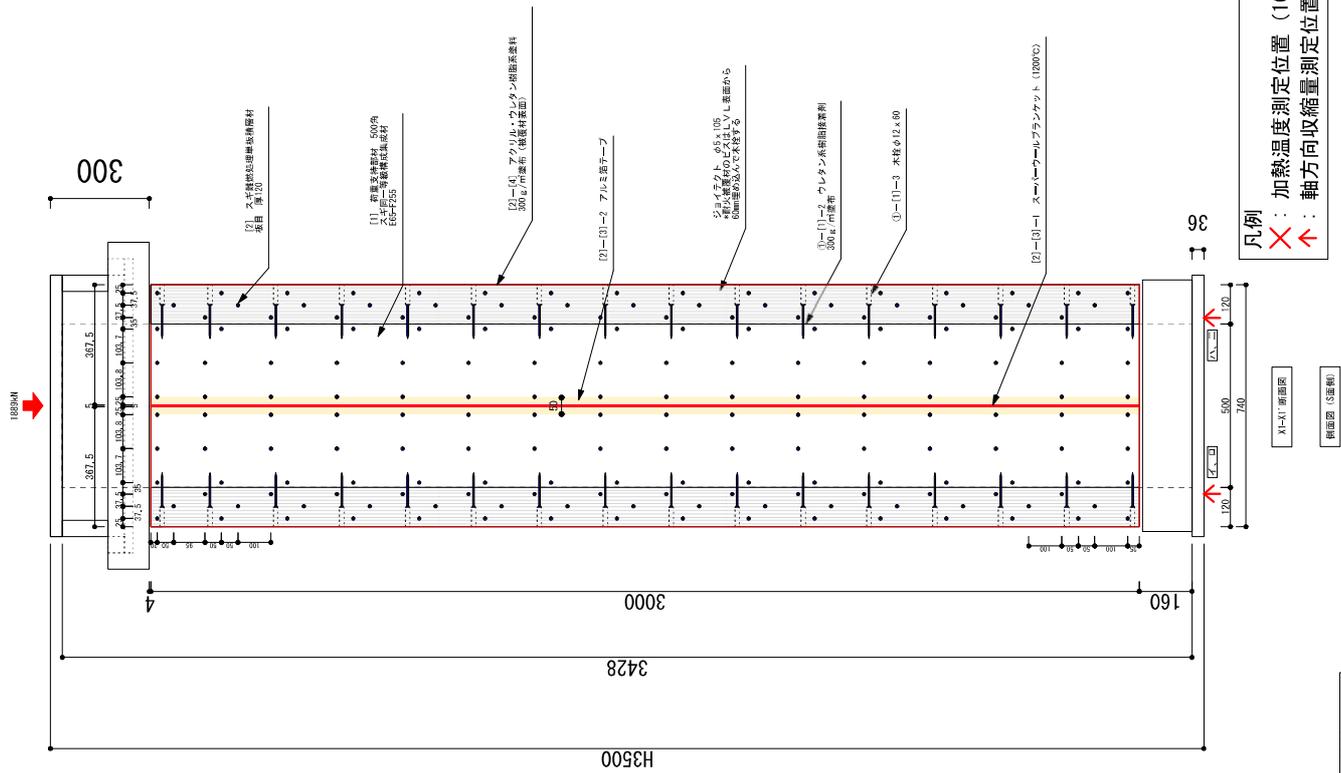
試験体の構造・寸法・温度測定位置 (寸法単位:mm)
